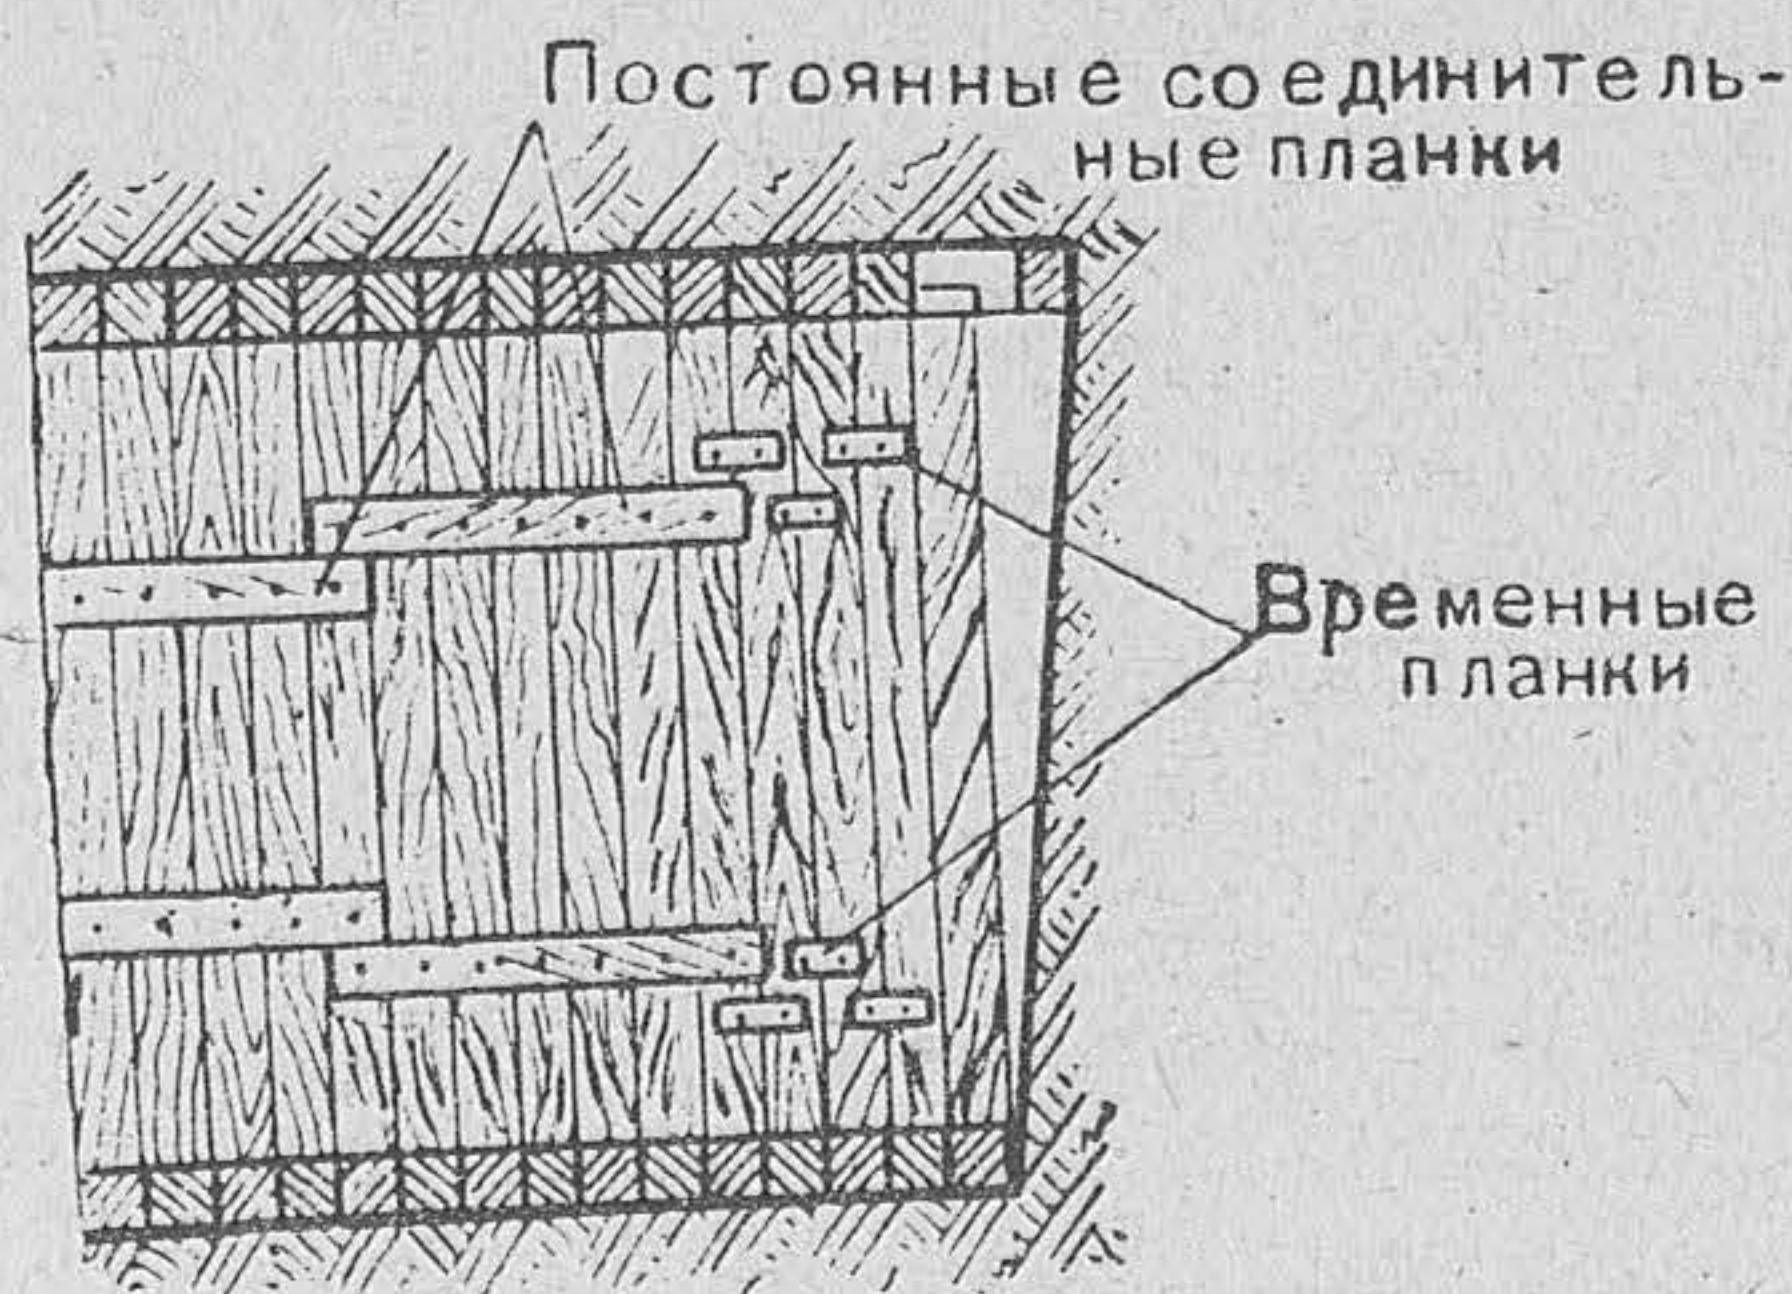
Проходка горизонтальных выработок в плотных грунтах
